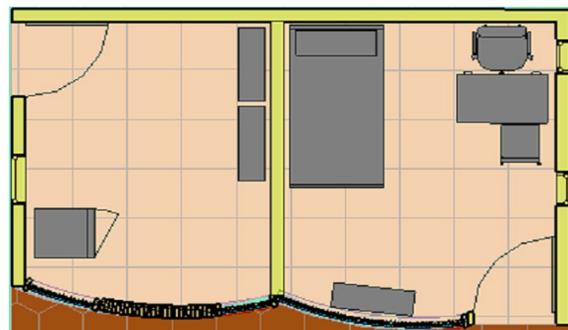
Planta arquitectónica de la enfermería y miscelánea.
